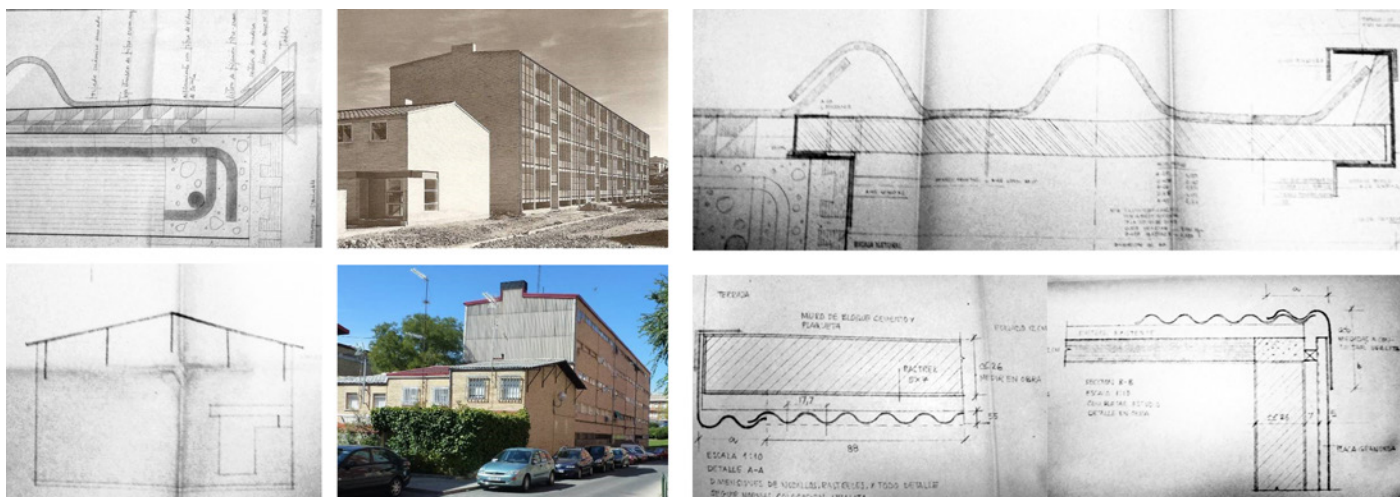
Nuevos aleros VU y testeros VCB (fotografías de la autora estado actual y [6]). Detalles constructivos Proyecto Original (35) y Proyecto reformado Ministerio de la Vivienda. P.D. de Fuencarral 1963 (42)
